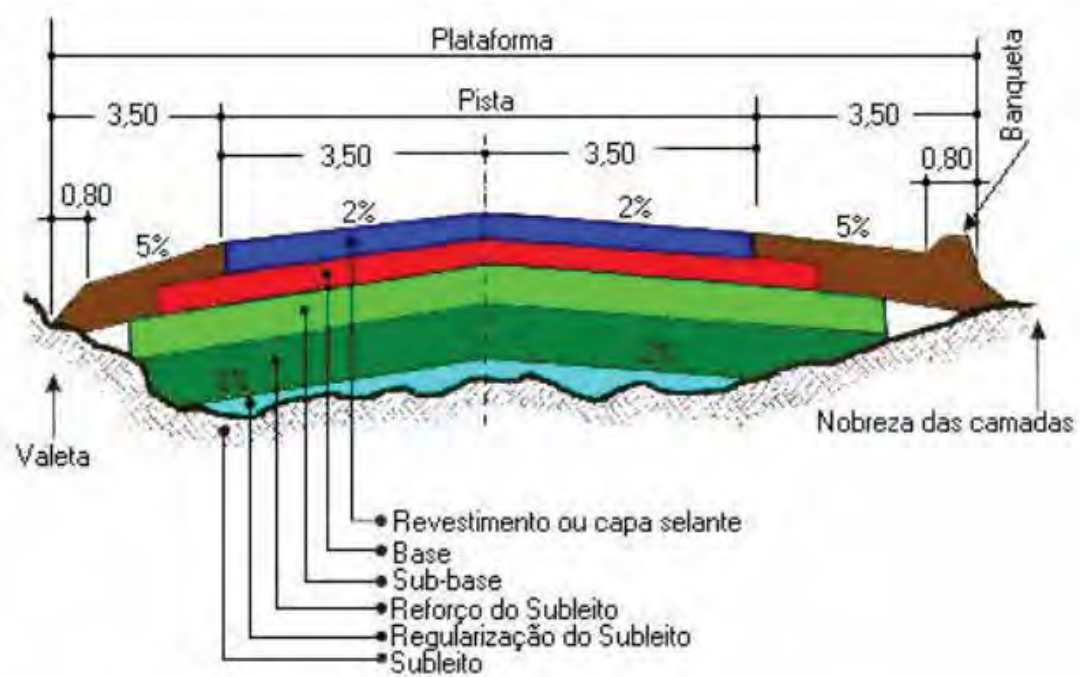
Seção transversal de uma estrutura de pavimento. Fonte: Adaptado de Senso, 1993.
